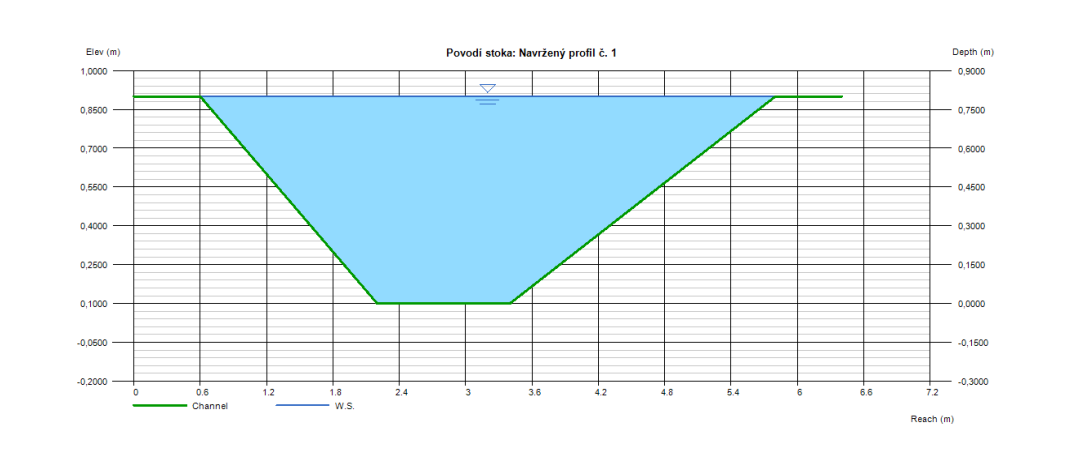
Návrh průřezného profilu 2, zdroj: vlastní
